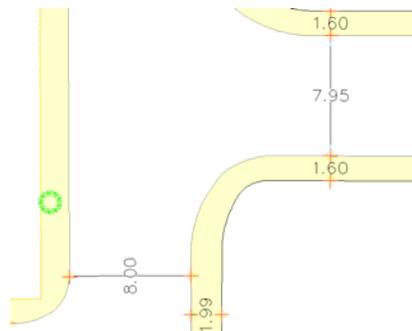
Esquina del terreno. Hacia Río Mixteco
